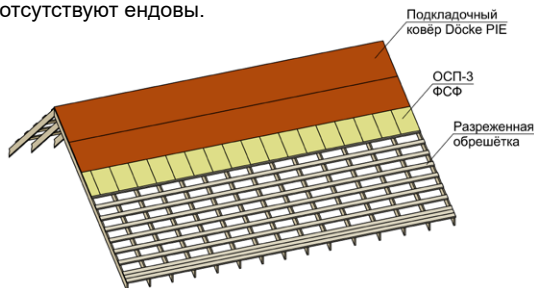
Схема укладки самоклеящихся подкладочных ковров на карнизный свес.
